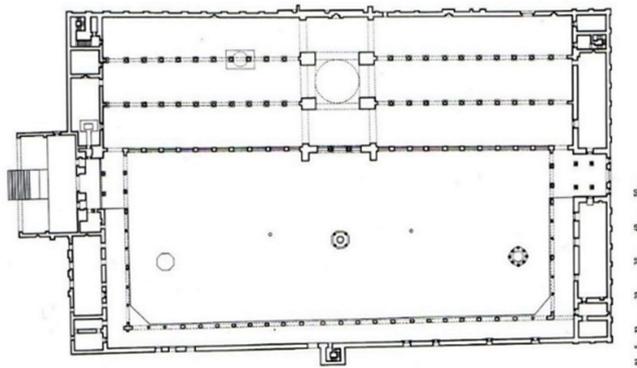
Umayyadenmoschee, Damaskus, Grundriss [7]
